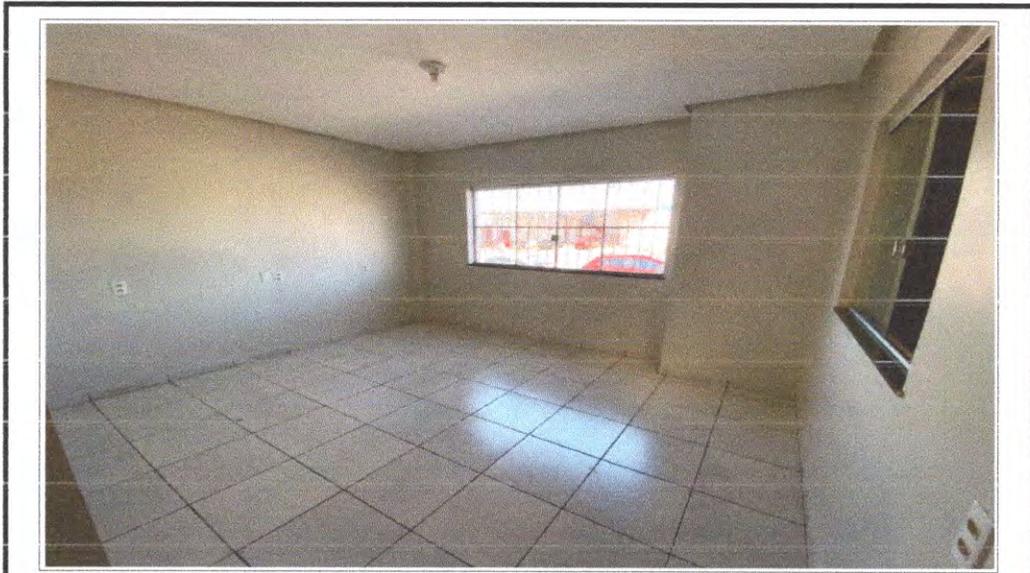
Sala 02 localizada no pavimento térreo do bloco 01.
